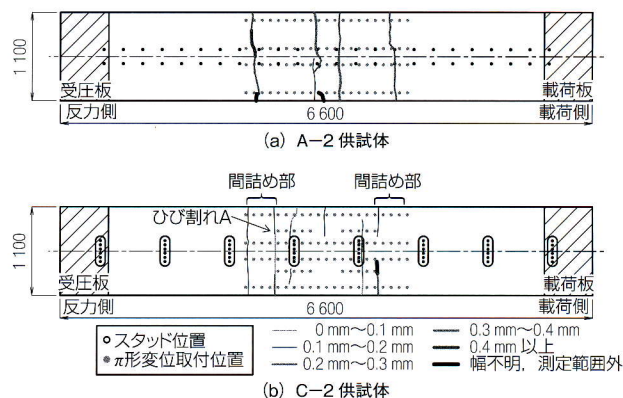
ひび割れ図(鉄筋応力度=140N/mm²時)
